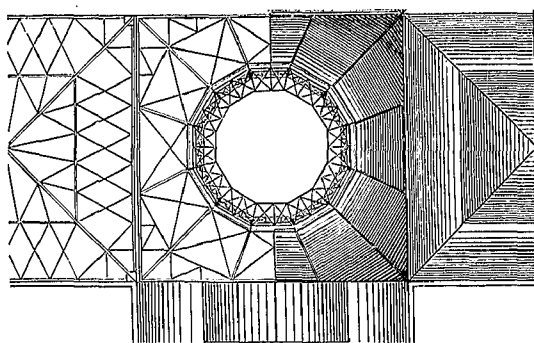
Grundriss der Dach- und Kuppel-Konstruktionen.
